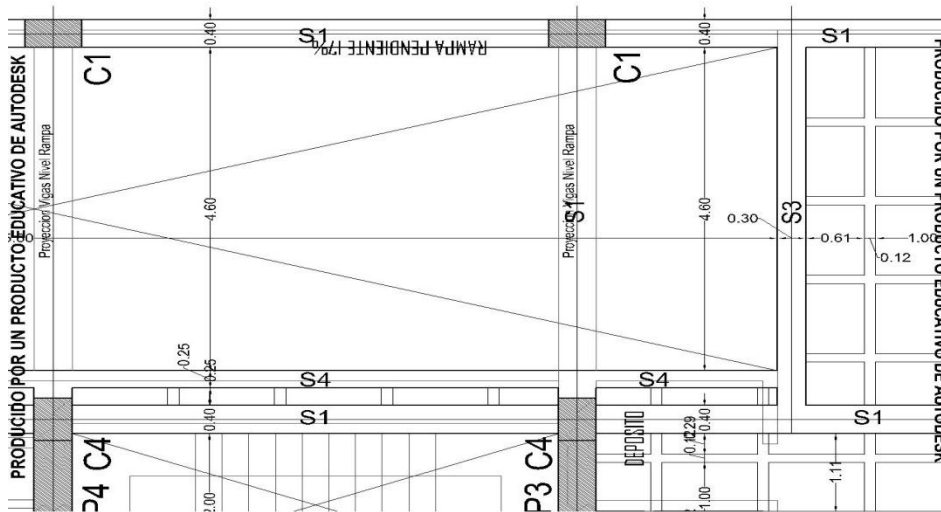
Vista en planta de acceso a la rampa, en donde la viga S4 fue removida para dar más ancho a la rampa de acceso.
